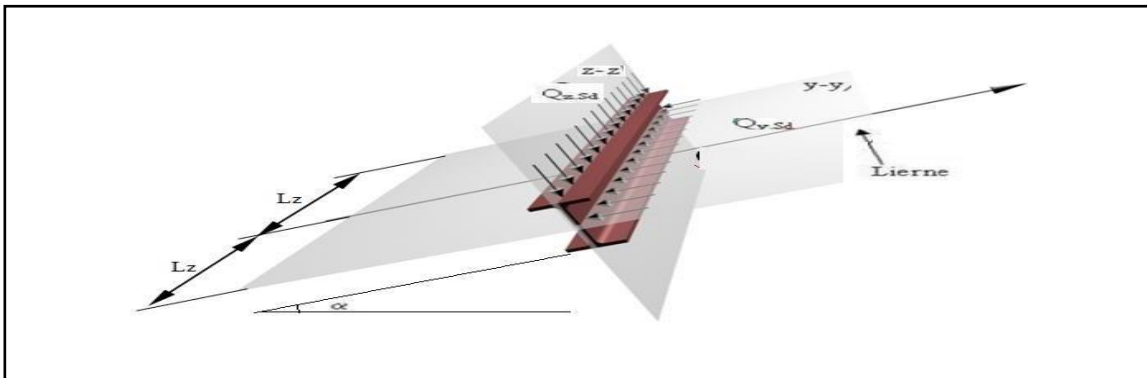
Panne de toiture en flexion sous les différents plans de chargement
